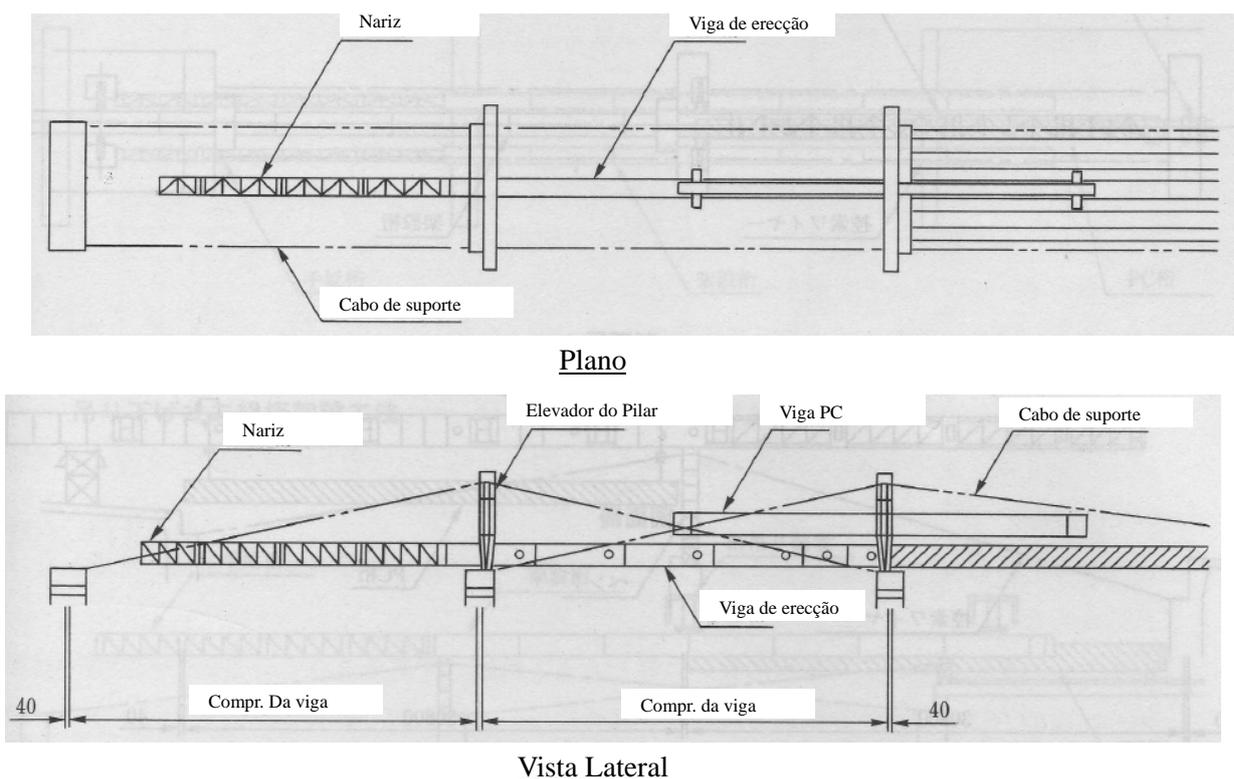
Ereccção Usando Viga de Ereccção
